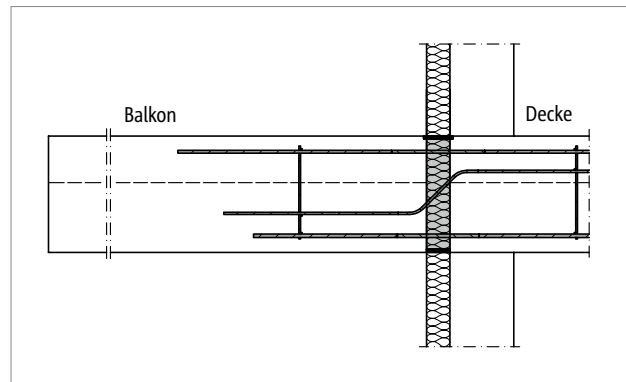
Schöck Isokorb® T Typ B: Balkonkonstruktion mit frei ausragenden Unterzügen
